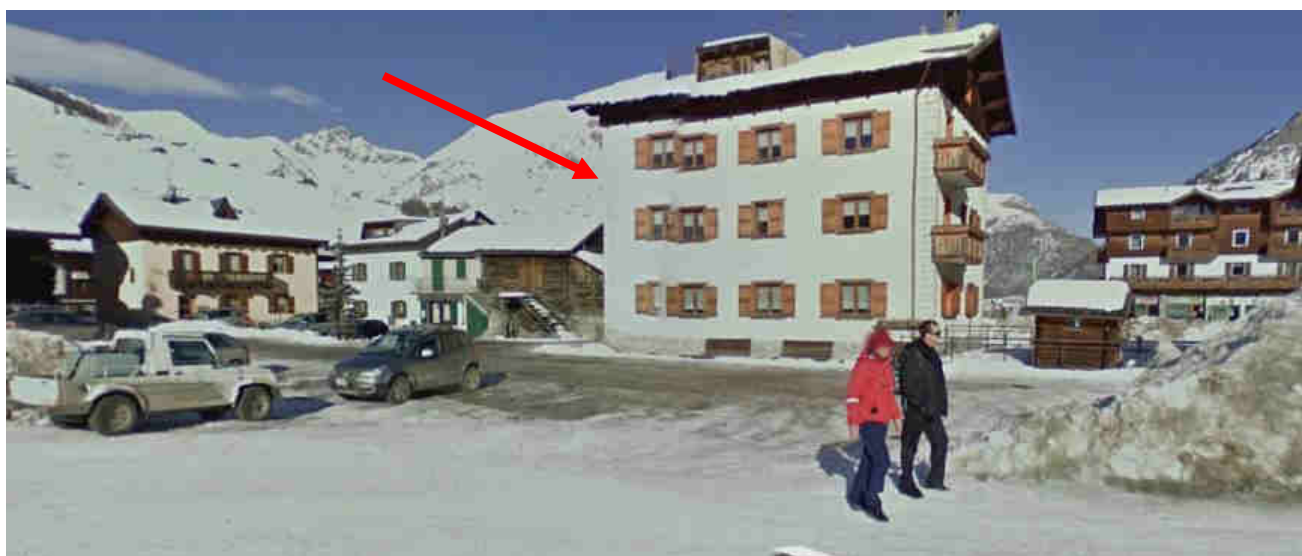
Prospetto ovest edificio esistente da ristrutturare (demolizione e ricostruzione)
